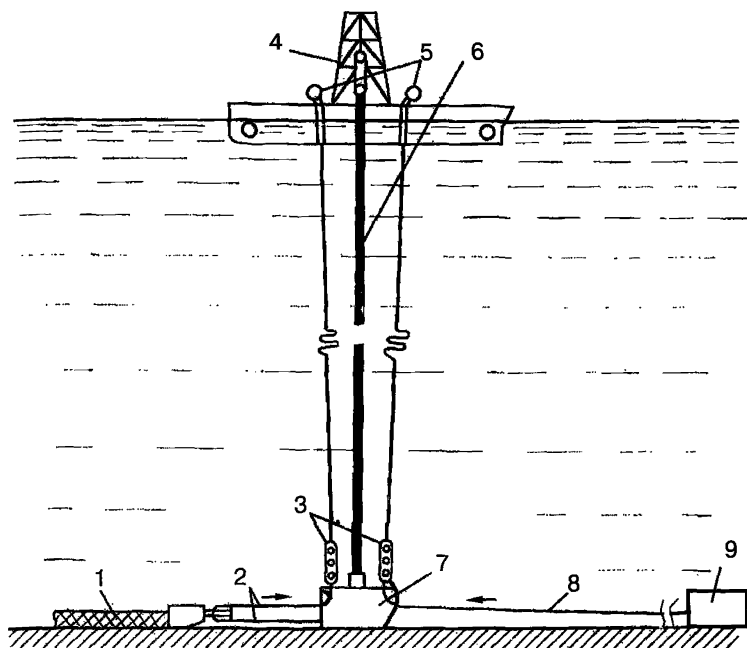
Схема протаскивания трубопровода с использованием перемещения донного груза:
